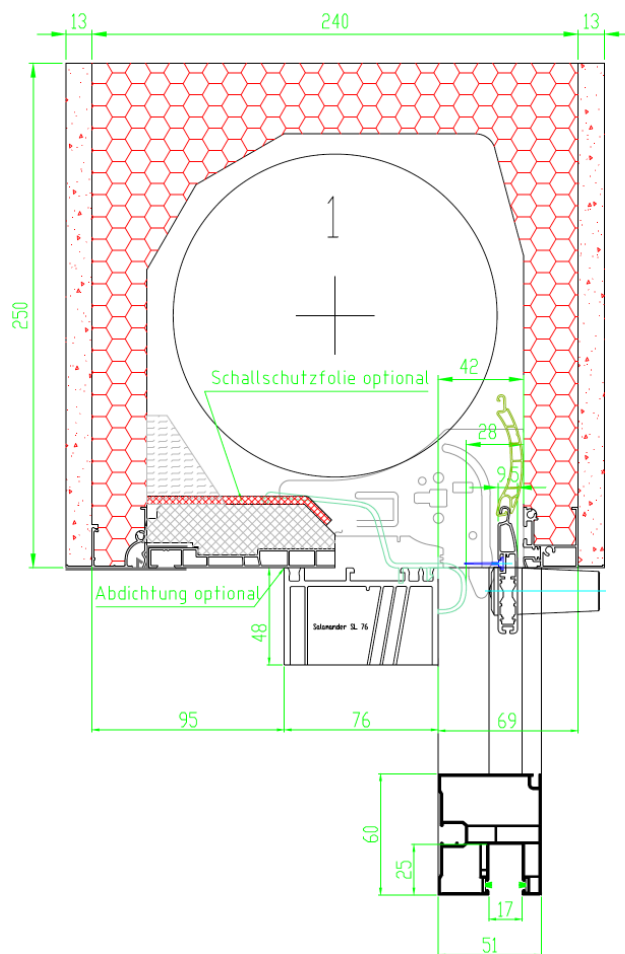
Schnittzeichnung (Grundsatzdetail, Ausführung mit Schallschutzfolie, Anschluss an Fensterrahmen abgedichtet)
